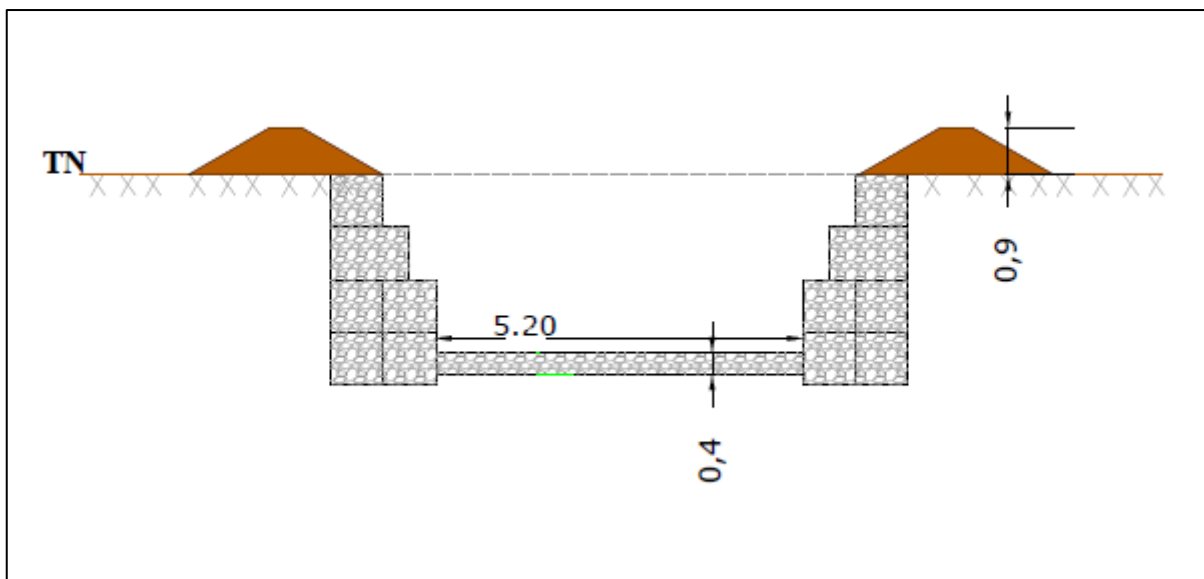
Schéma d'un aménagement en mur de soutènement en gabionnage (Section rectangulaire).
